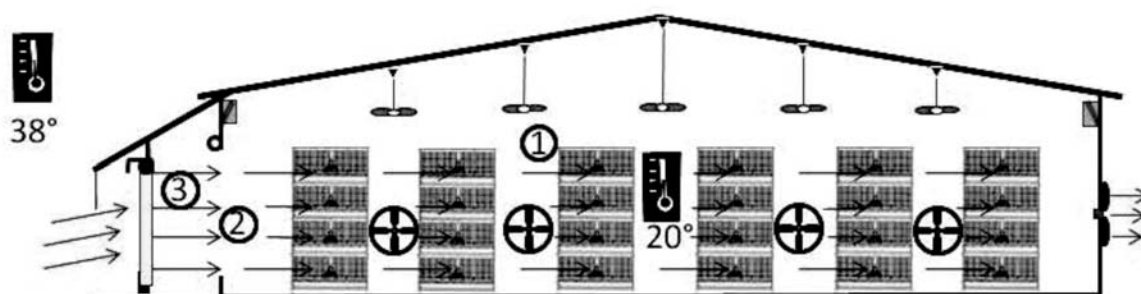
Поперечный тоннель (Cross Tunnel)
